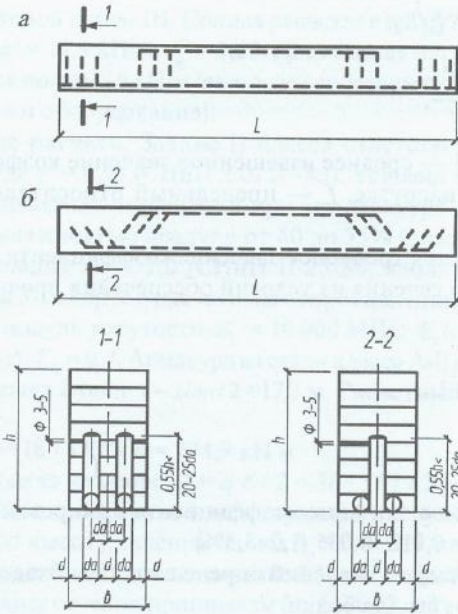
Армирование балок полукаркасами: а — каркас с поперечными стержнями, приваренными перпендикулярно к продольной арматуре; б — каркас с наклонными стержнями под углом
